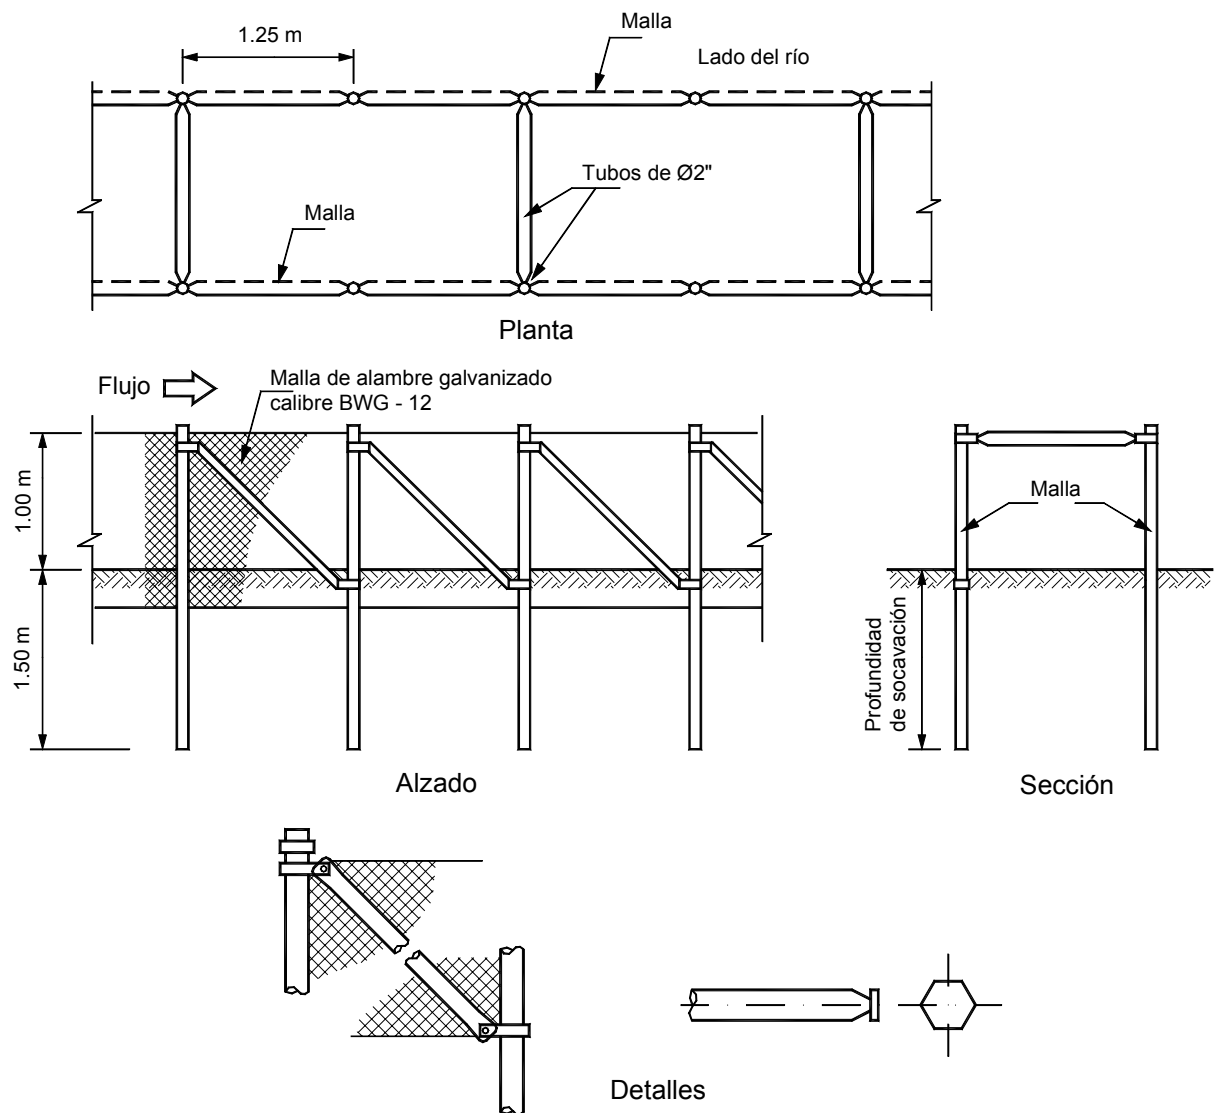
Retardadores en pilotes con malla metálica.
